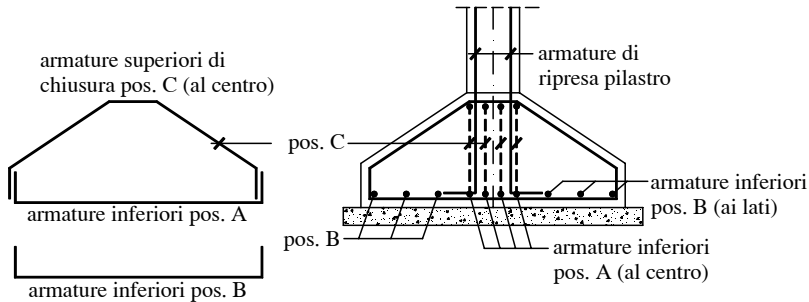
Disposizione schematica delle armature nel plinto di fondazione.
